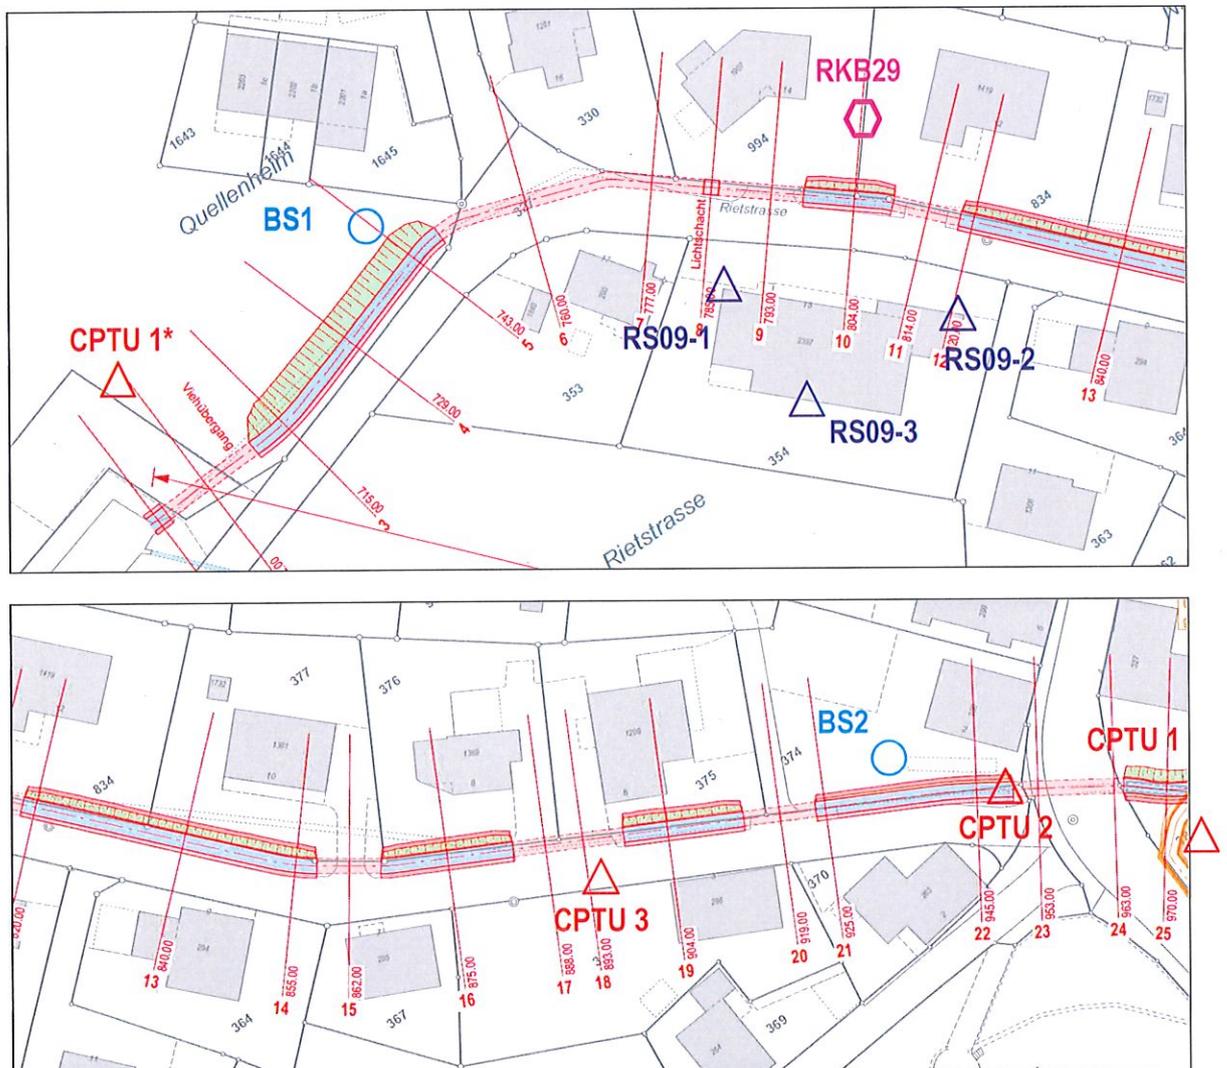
und 7: Bachabschnitt 7 mit den Standorten der Baggerschlitze BS1 und BS2, der Rammkernbohrung aus dem Jahr 1965 [10] und den Rammsondierungen aus dem Jahr 2009 [7] und den Drucksondierungen aus dem Jahr 2019 im Massstab 1:1'000.
